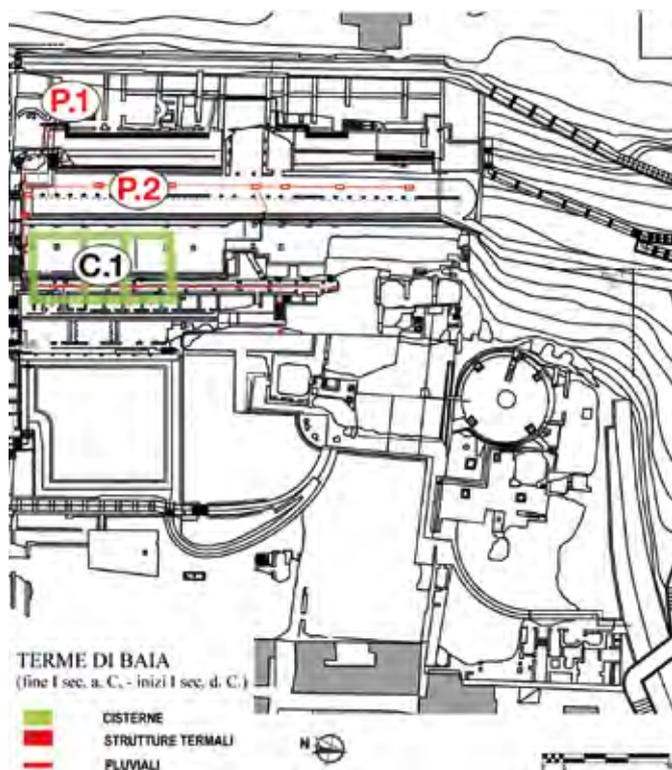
Planimetria con le strutture idrauliche di I fase (rielaborazione di D. De Simone e G. Ferrari).
